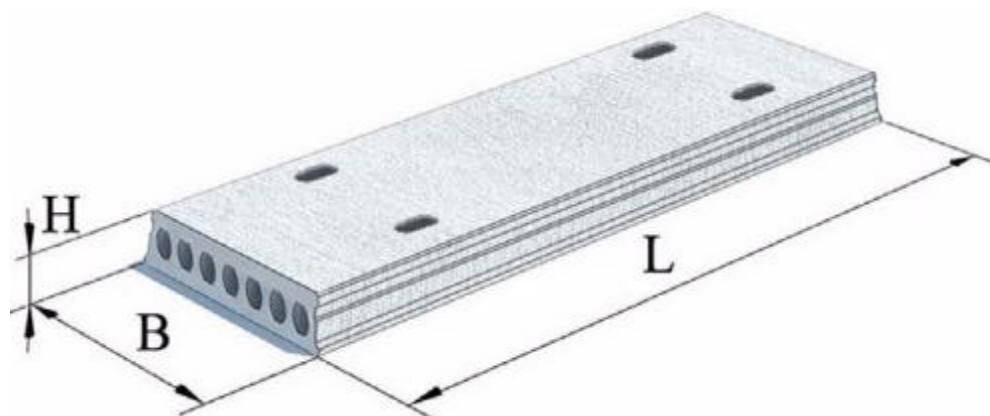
Зовнішній вигляд залізобетонної плити перекриття круглопустотної
